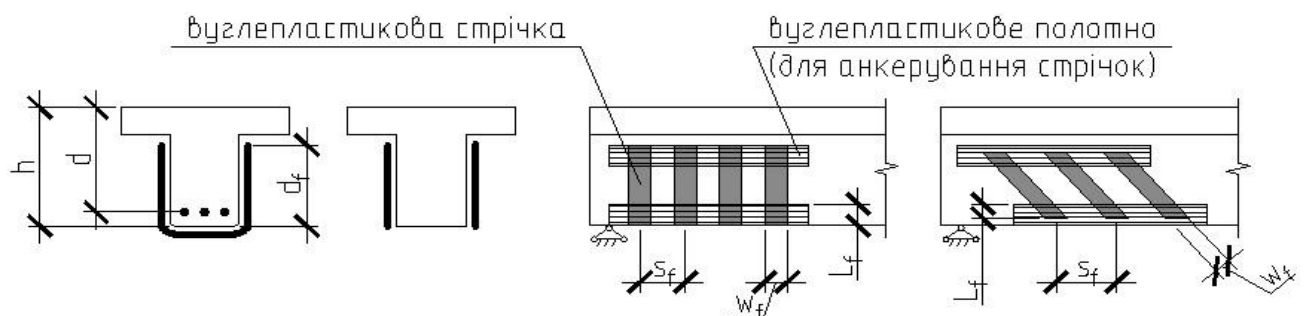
Для розрахунку залізобетонних елементів, підсилених зовнішньою вуглепластиковою поперечною арматурою
